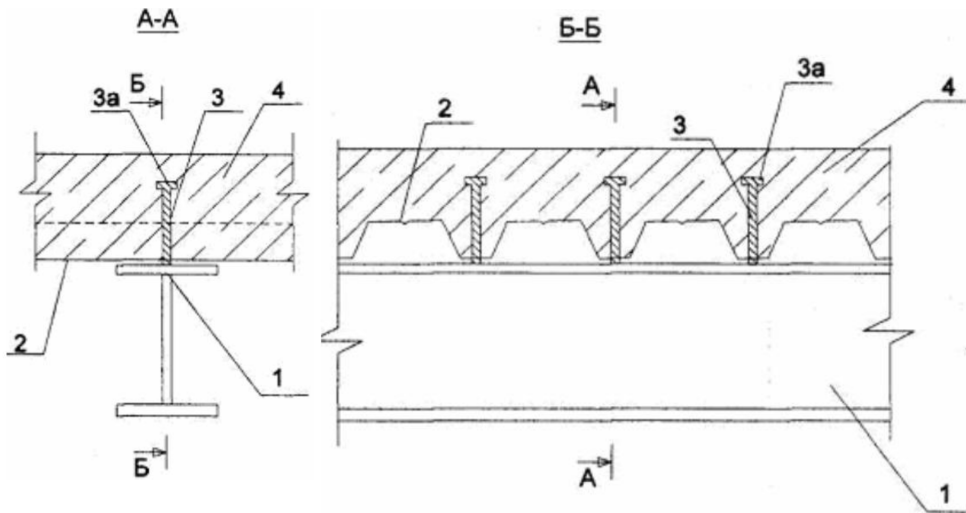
Сталезалізобетонне перекриття: 1 – сталева балка; 2 – сталевий профільований настил; 3 – сталеві гнучкі стержньові анкери; 3а – головки на анкерах; 4 – монолітна залізобетонна плита
